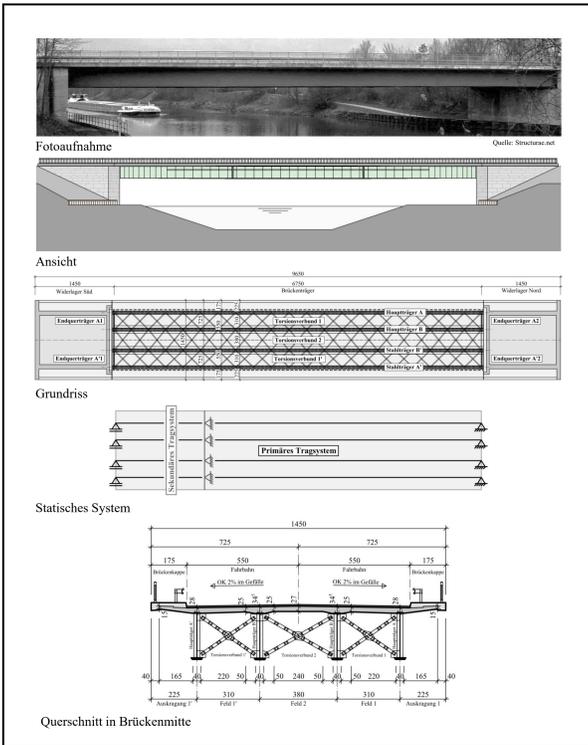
Bestehende Stahl-Beton-Verbundbrücke
